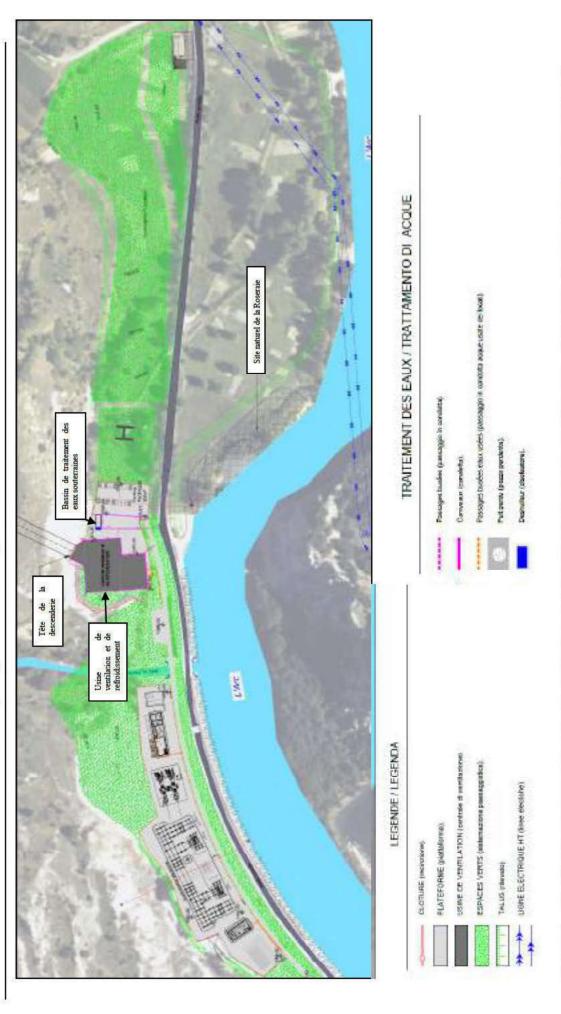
Croquis présentant les aménagements envisagés pour le secteur de Villarodin-Bourget/Modane - Source:Plan de masse sur orthophotos-génie civil-4102\_0\_26-12-30\_30-02\_Plan de masse orthophoto tunnel de base- accès Modane- portail et plateforme- référence: PR\_C3A\
